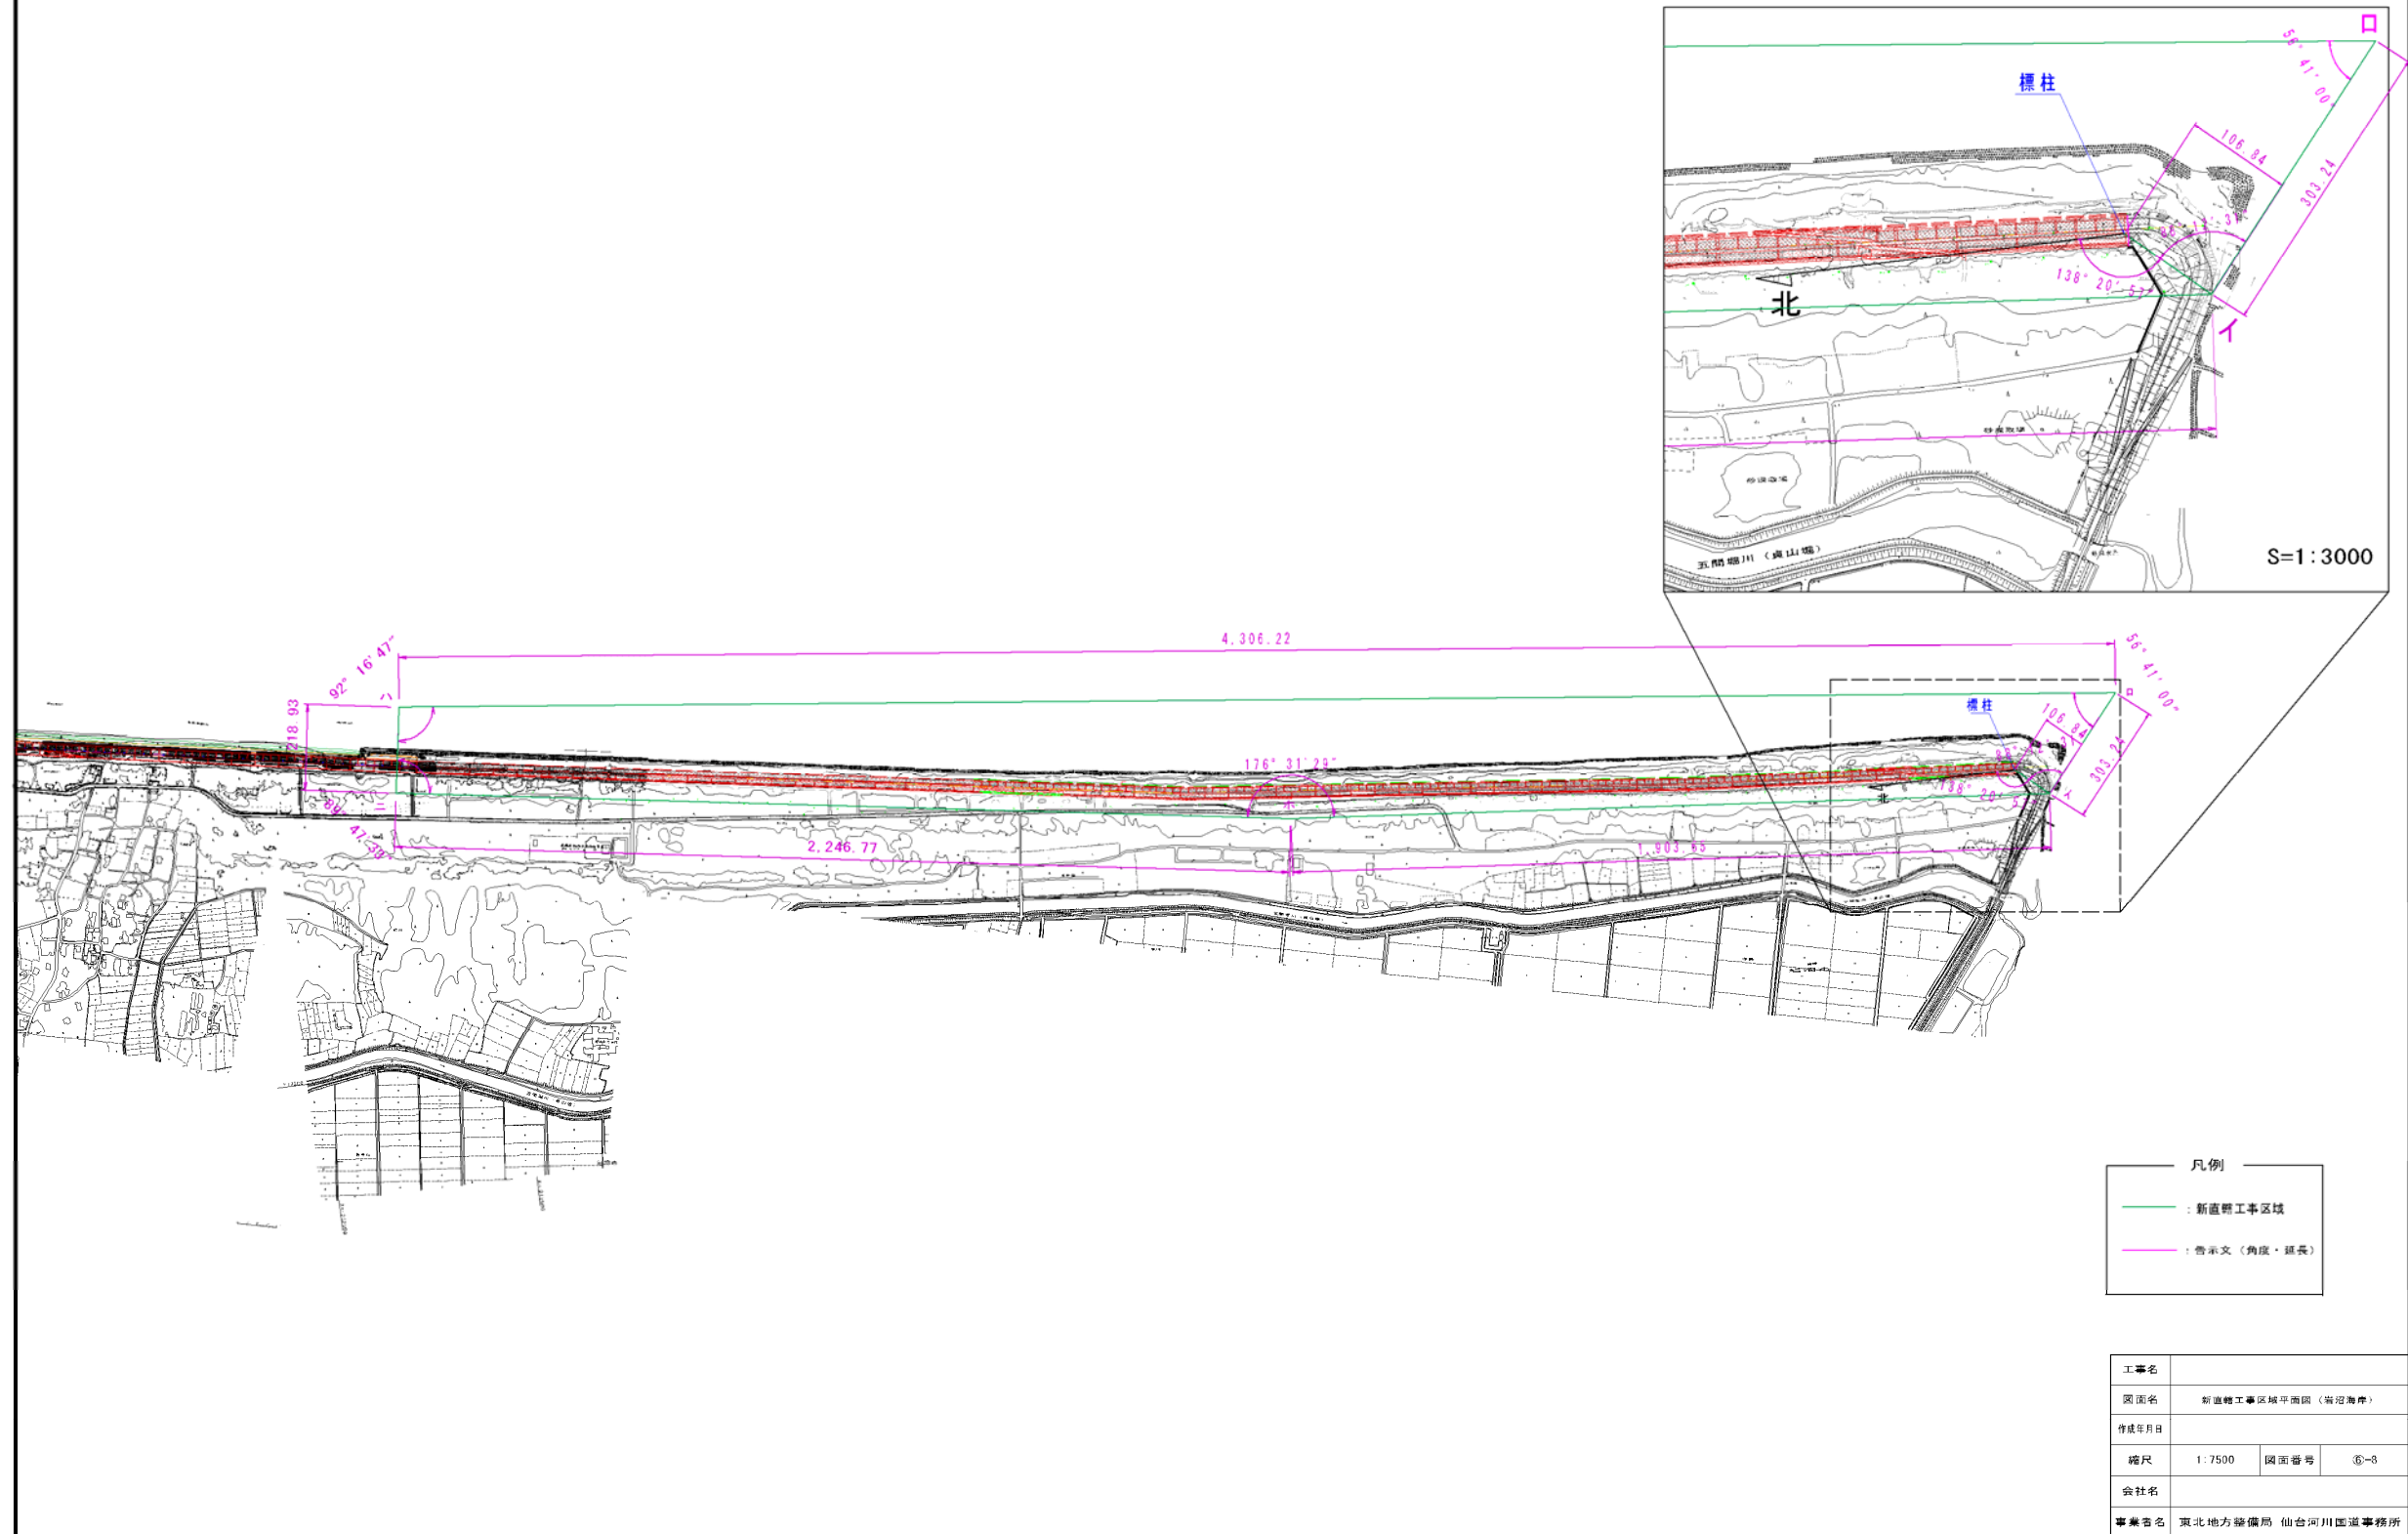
新直轄工事区域平面図(岩沼海岸)
